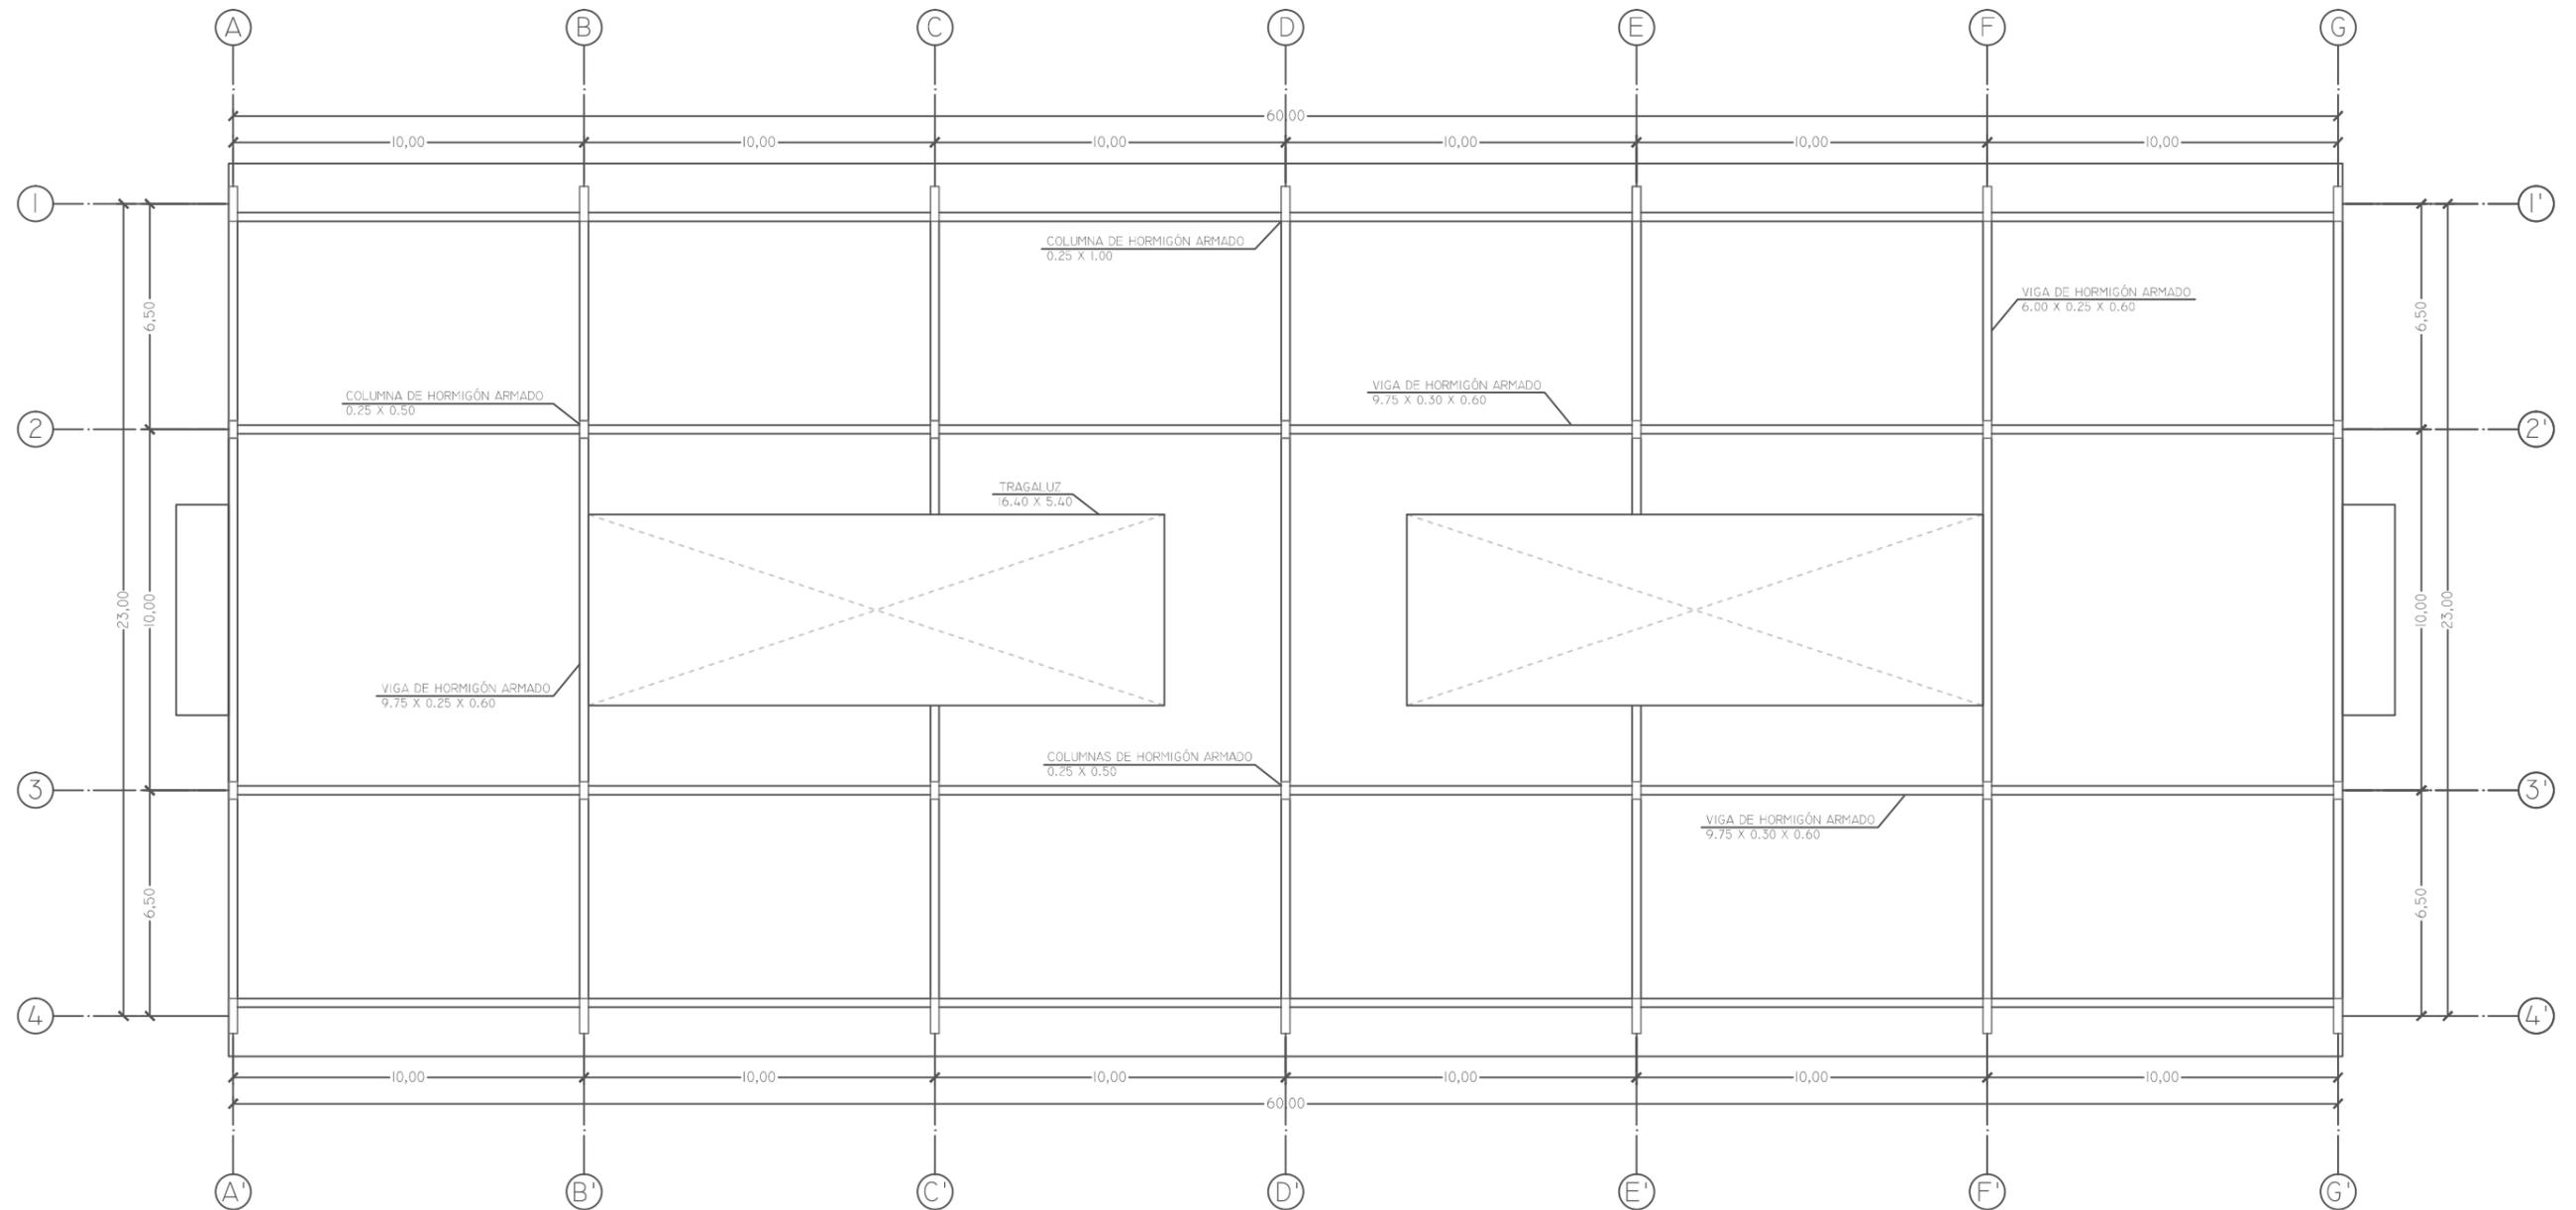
Planta Estructural de Losa de Tercer Piso
